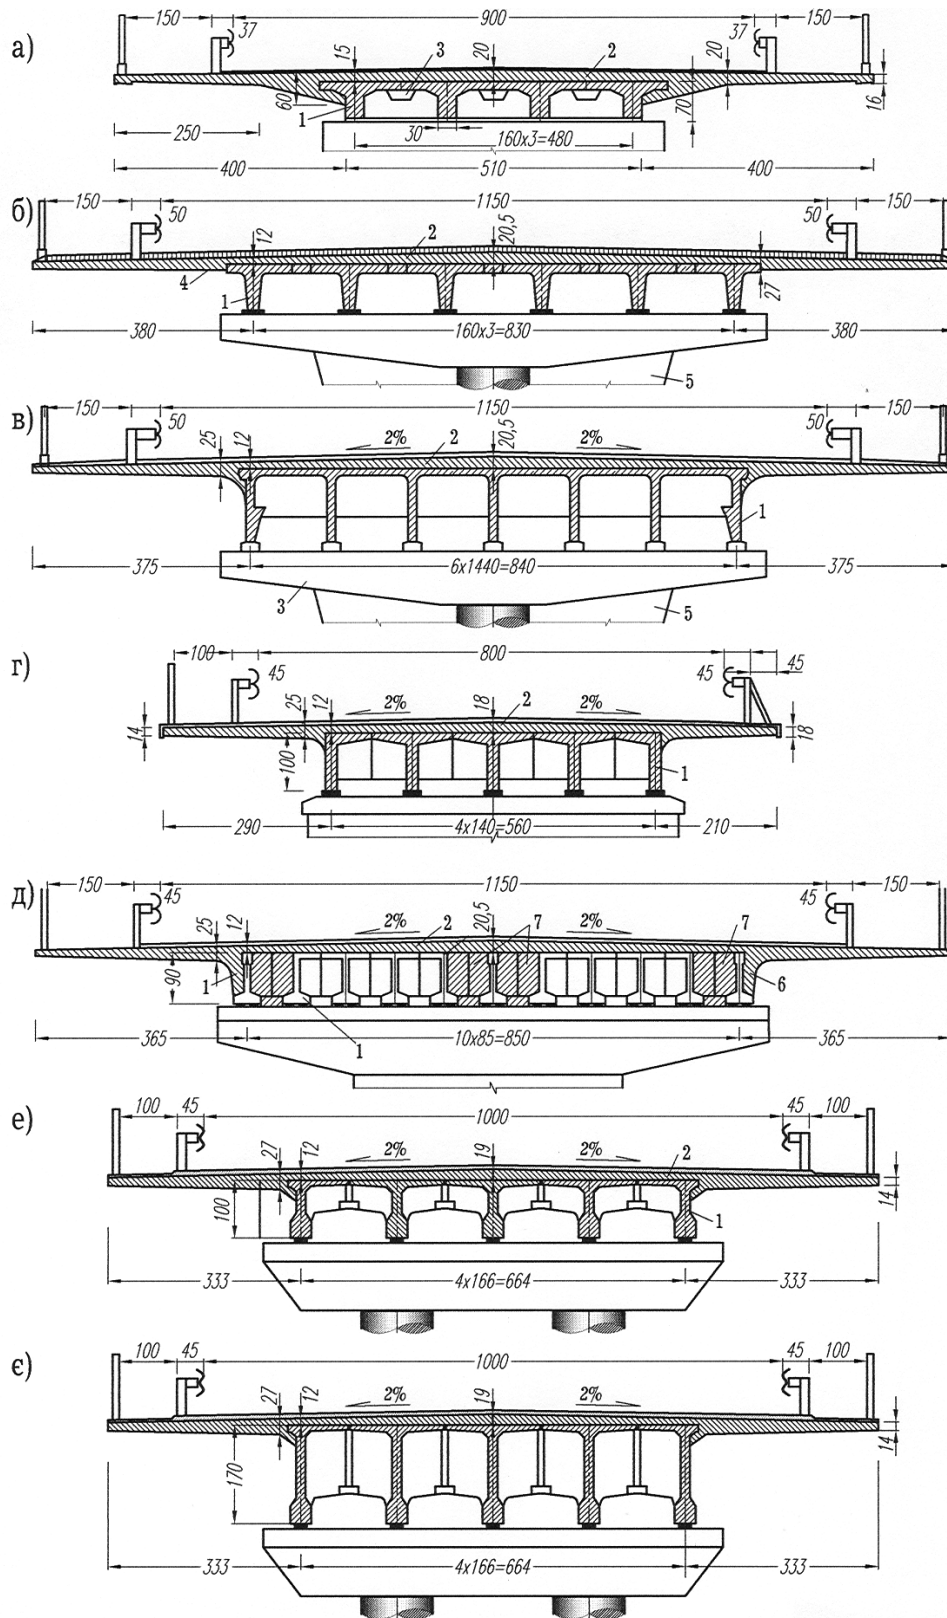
Схеми розширення прольотних будов різних типів монолітною залізобетонною накладною плитою:
